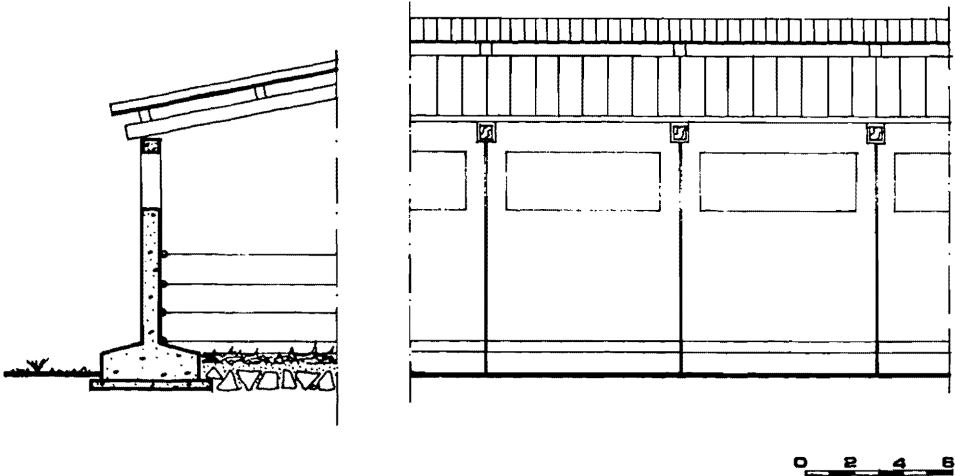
Esempio di parete autoportante ed autostabilizzante prefabbricata in calcestruzzo normale o alleggerito con additivi ed inerti leggeri, oppure di tipo cellulare ottenuto insufflando aria nel getto.
